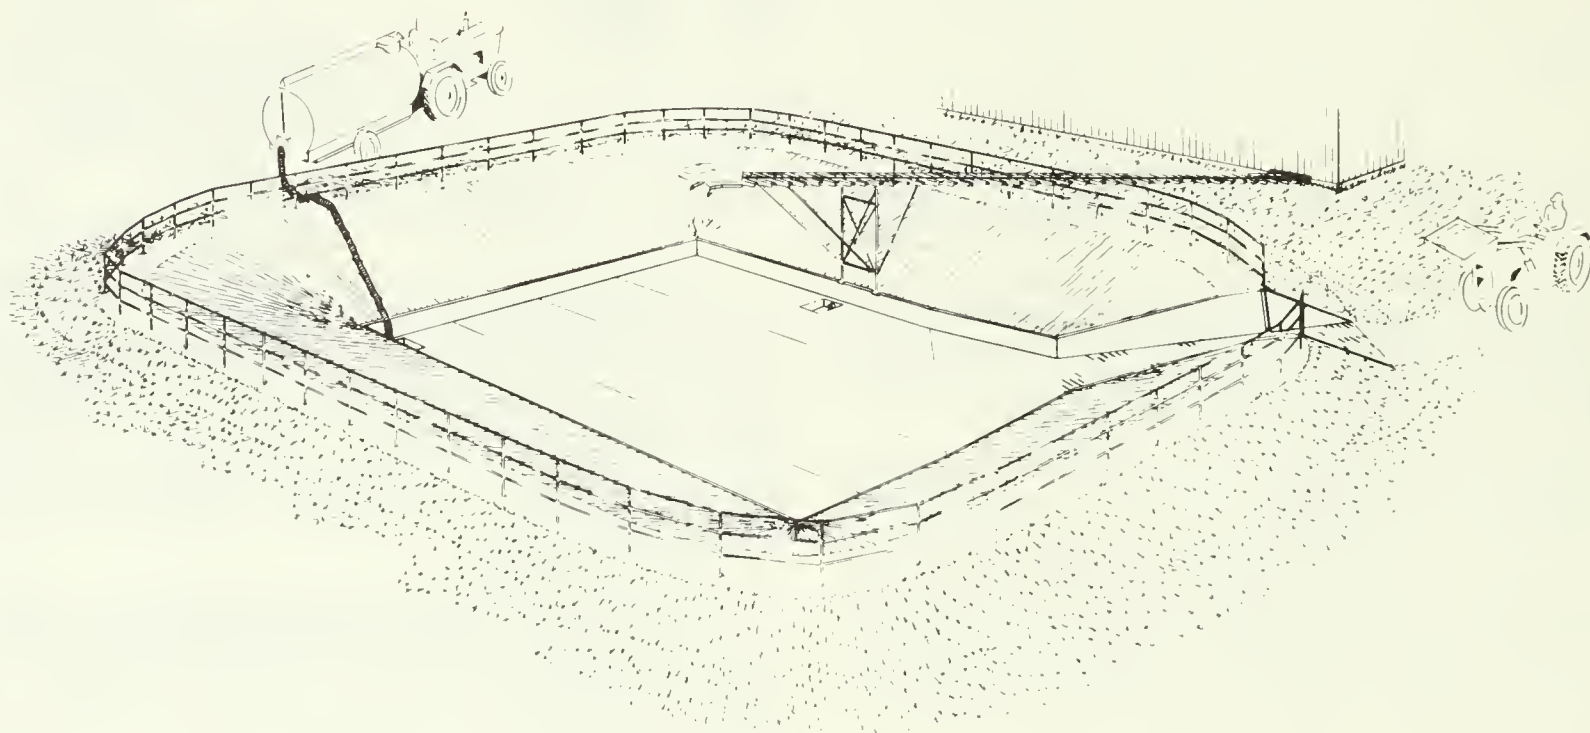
Plate-forme convexe à muret munie de remblai de terre (S.P.C., plan n° M-2704)
